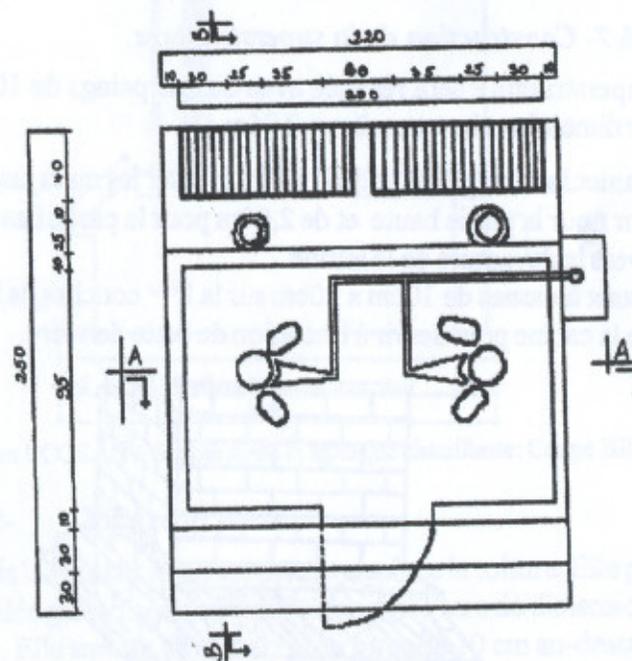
Latrine ECOSAN à double fosse et à plaque chauffante: vue en plan de la dalle de couverture
